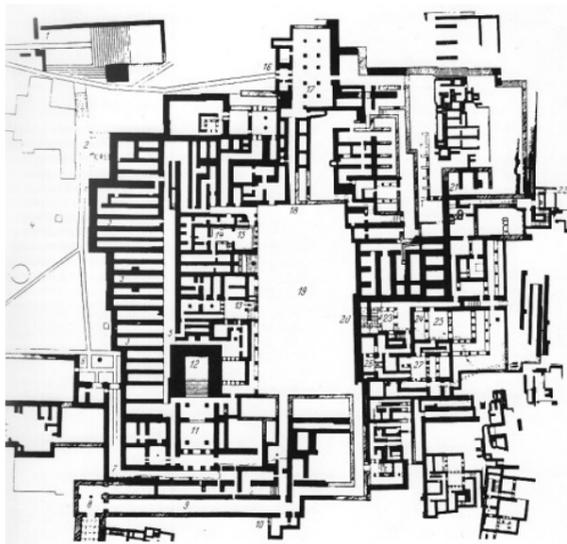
Rekonstruierter Grundriss vom Knossos-Palast
